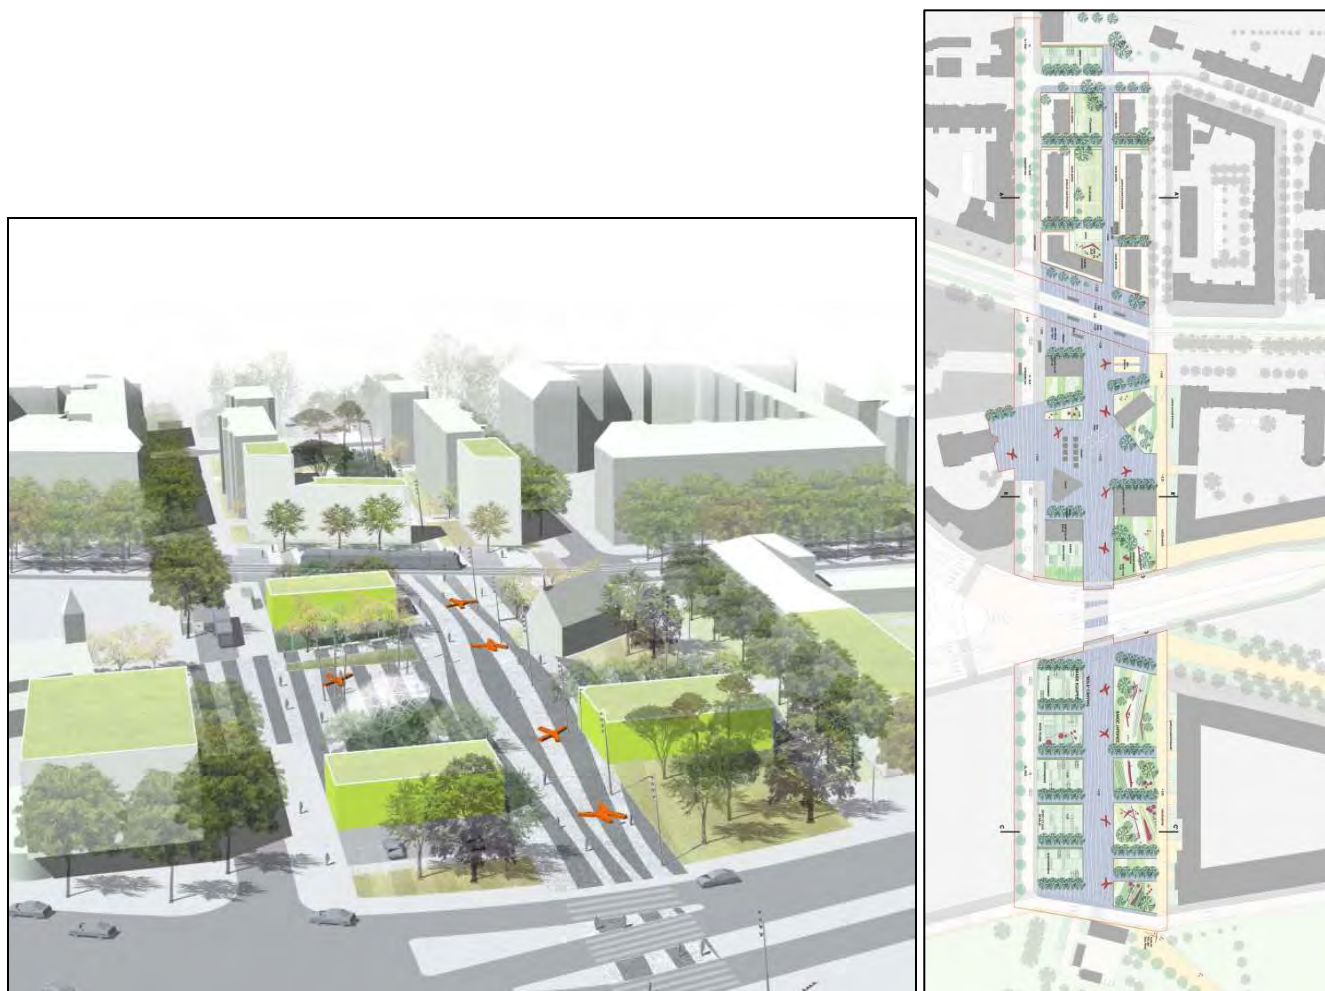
Place de l'hippodrome – perspective et plan masse
